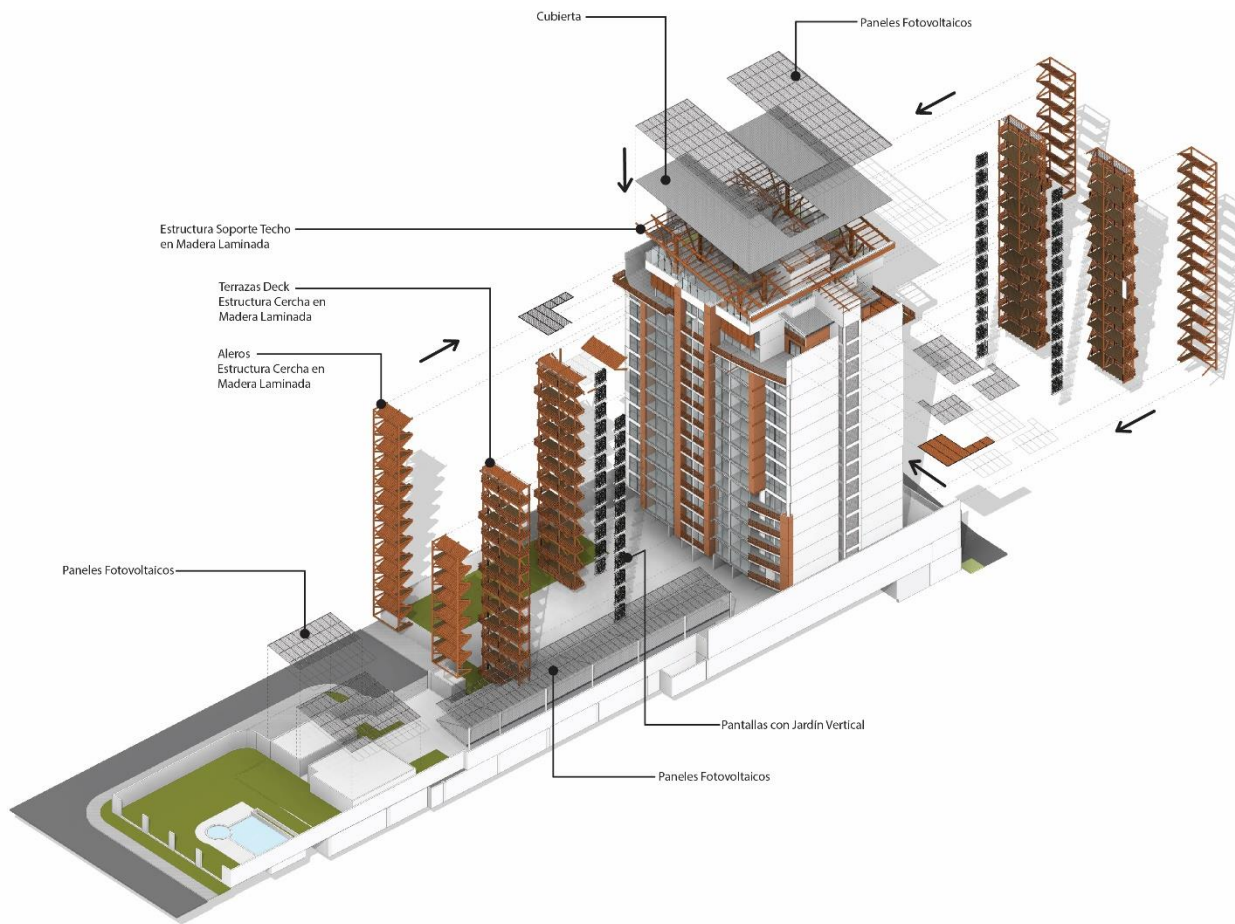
Planta Conjunto 3D Explotado de la propuesta del proyecto. Fuente: Elaboración propia
